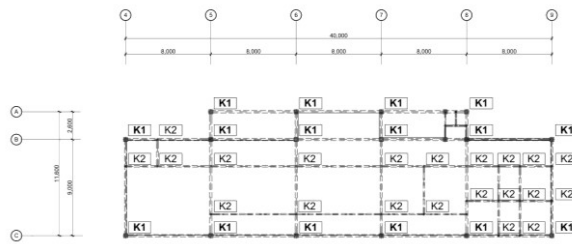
61 Skematik Struktur Kolom Lantai 1
